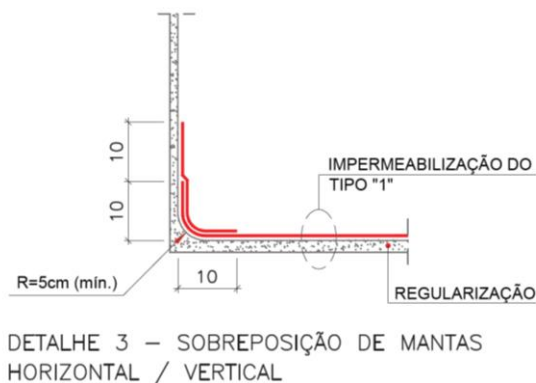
Detalhe construtivo de impermeabilização - sobreposição de mantas.
